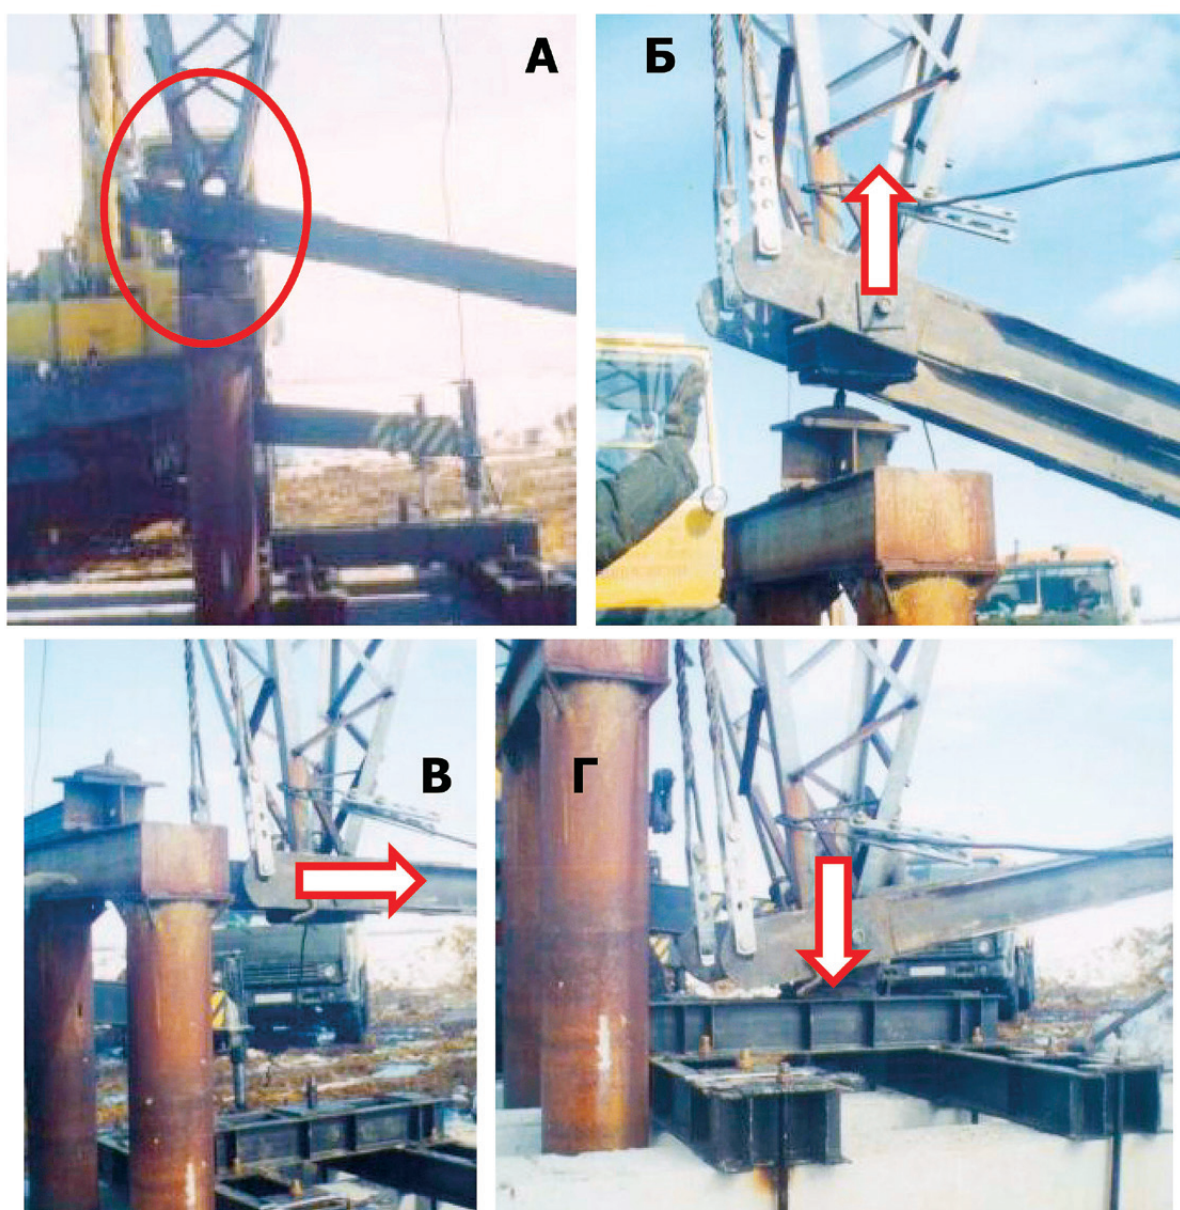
Перестановка опор ПБ-1 на новые фундаменты без отключения ВЛ
